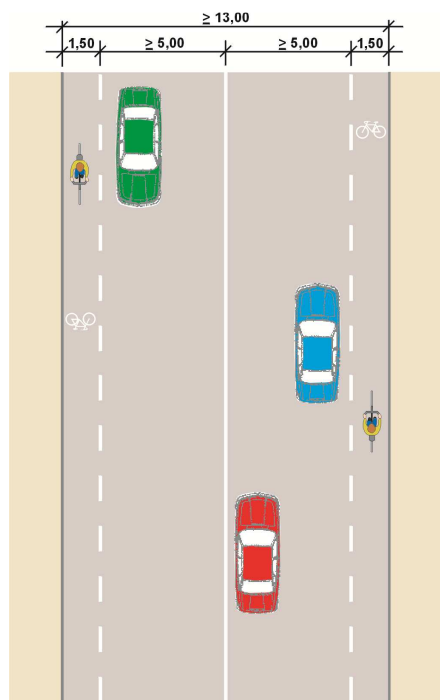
Schutzstreifen bei vierstreifig befahrbarer Straße
